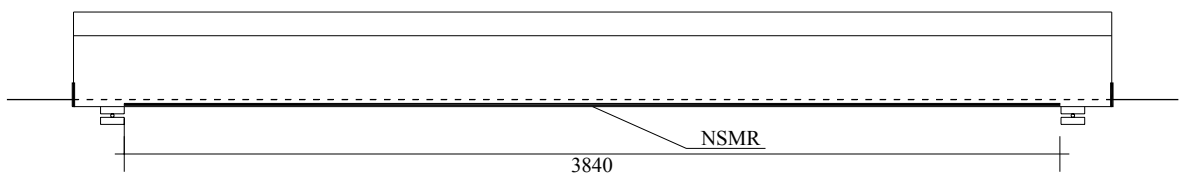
Detalhamento longitudinal do reforço com a técnica NSMR
